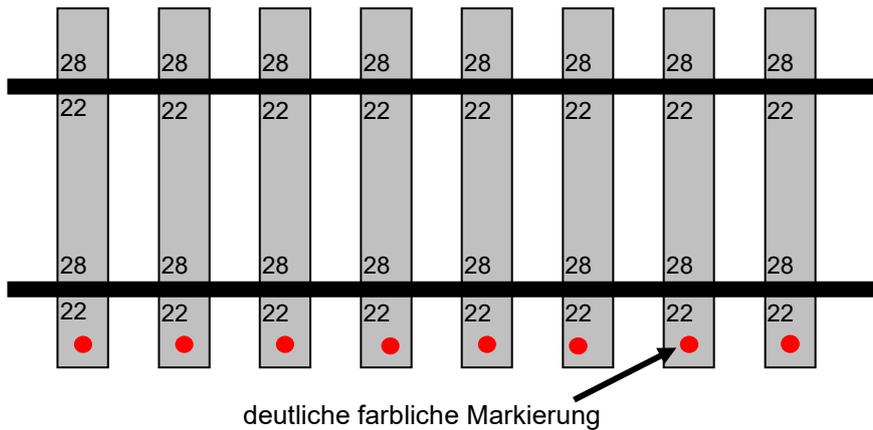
Beispielbild für Montage der W97 Befestigung bei Sickenmaß < 1812 mm.
